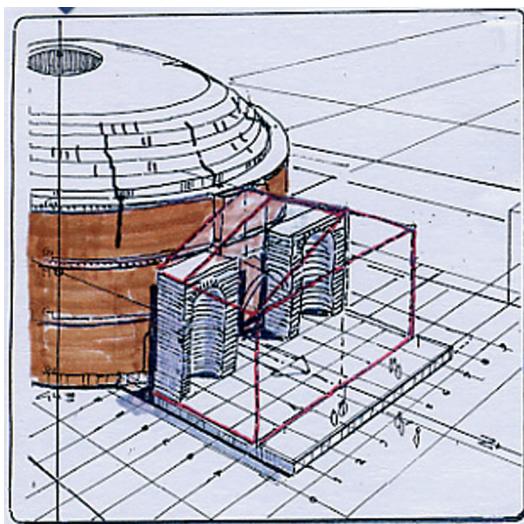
Im Innern der Rotunde beginnt man mit der Ausschalung der Kuppel (Kassetten) von oben nach unten. Parallel dazu erfolgen Nachbesserungsarbeiten. Abtransport der Schalungskörper. Das Montagegerüst wird parallel zur Ausschalung ebenfalls abgebaut.
